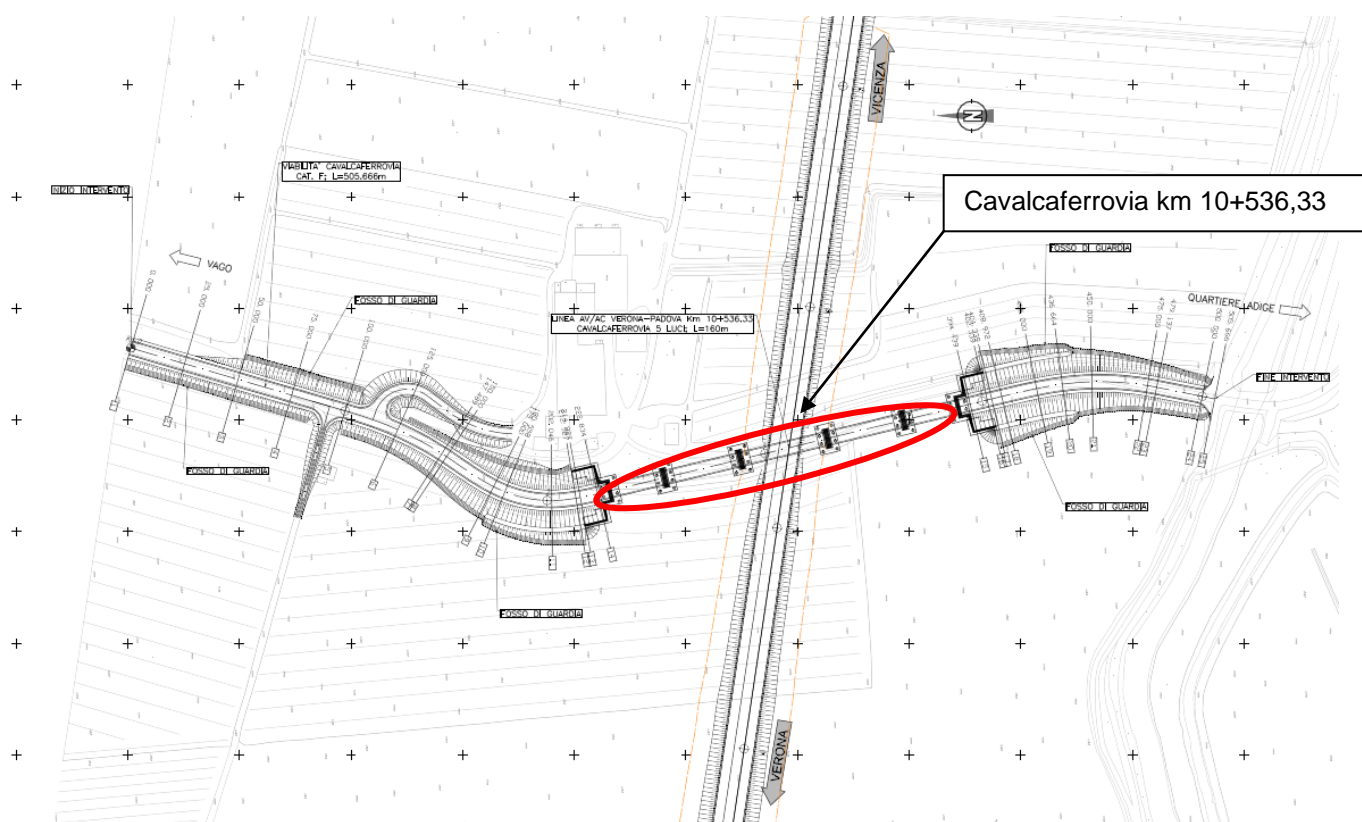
Stralcio planimetrico – ubicazione opera d’arte
